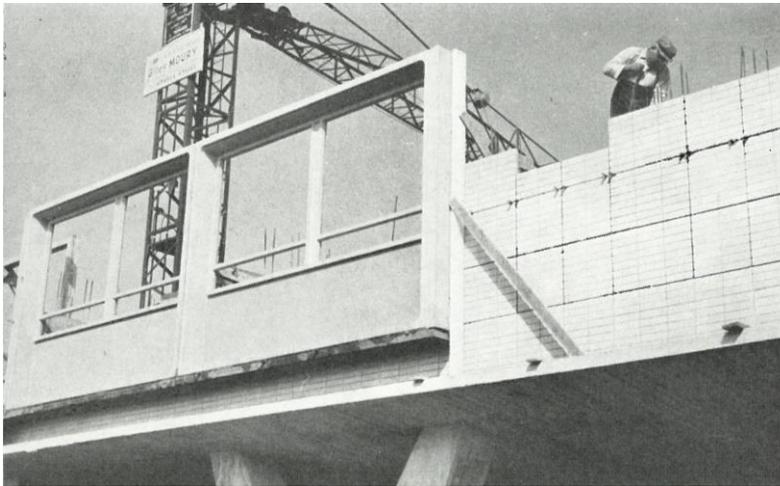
Montage des façades des immeubles du secteur Truffaut.
